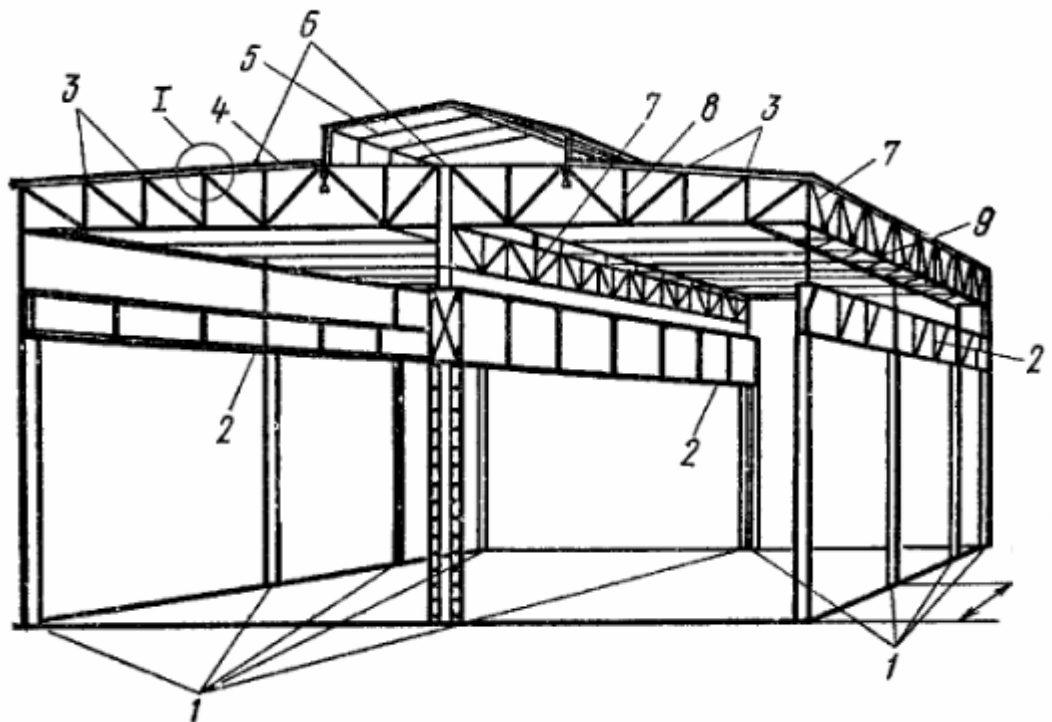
Конструктивна схема каркасу одноповерхової промислової будівлі: 1 — колони, 2 — підкранові балки, 3 — прогони, 4 — покрівля, 5 — світлоаераційний ліхтарь, 6,9 — в'язі, 7 — підкроквяна ферма, 8 — підкроквяна ферма
